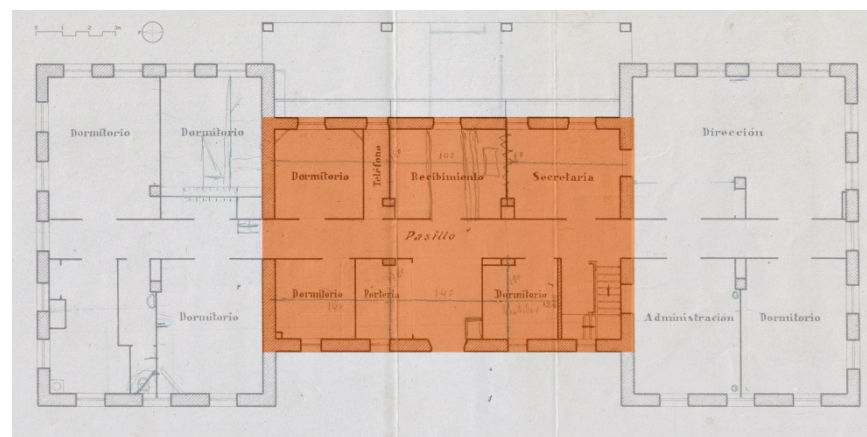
Emplazamiento edificio original Fase 1. Pabellón de Administración. 1906-1917.
